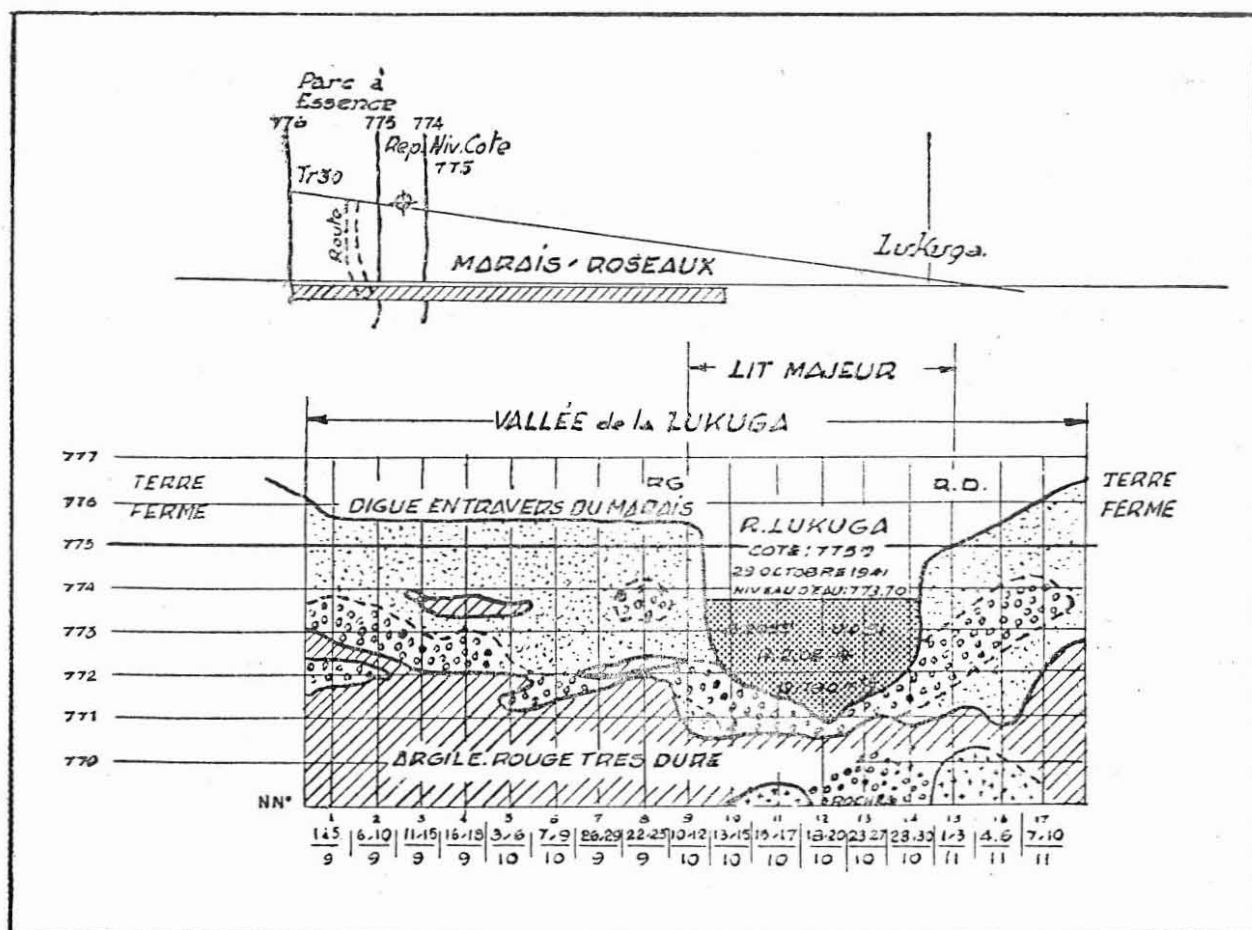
Coupe du terrain à l'emplacement II du barrage de la Lukuga (Traverse 30 : voir planche II).
